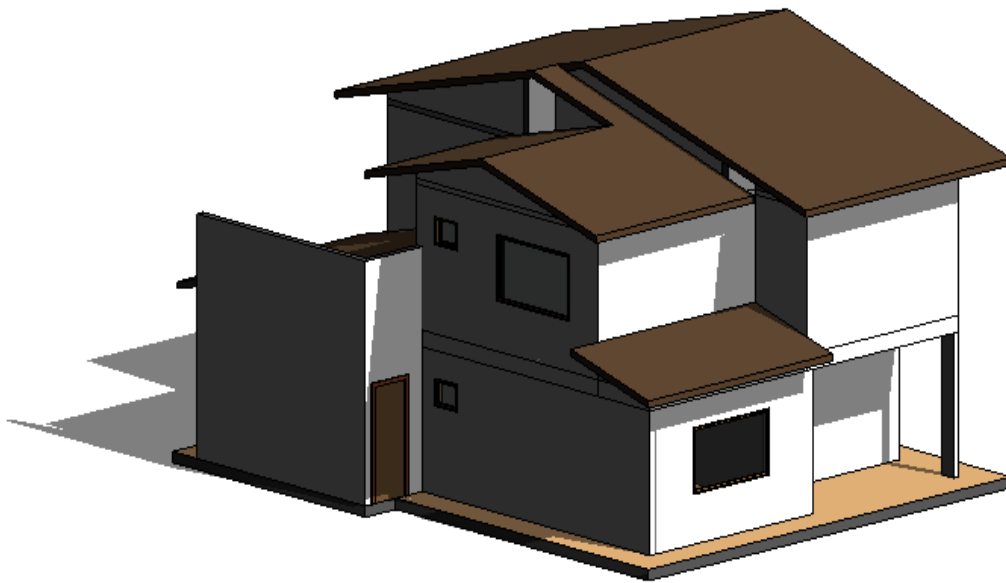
Modelo tridimensional da elevação posterior e vista lateral direita.
